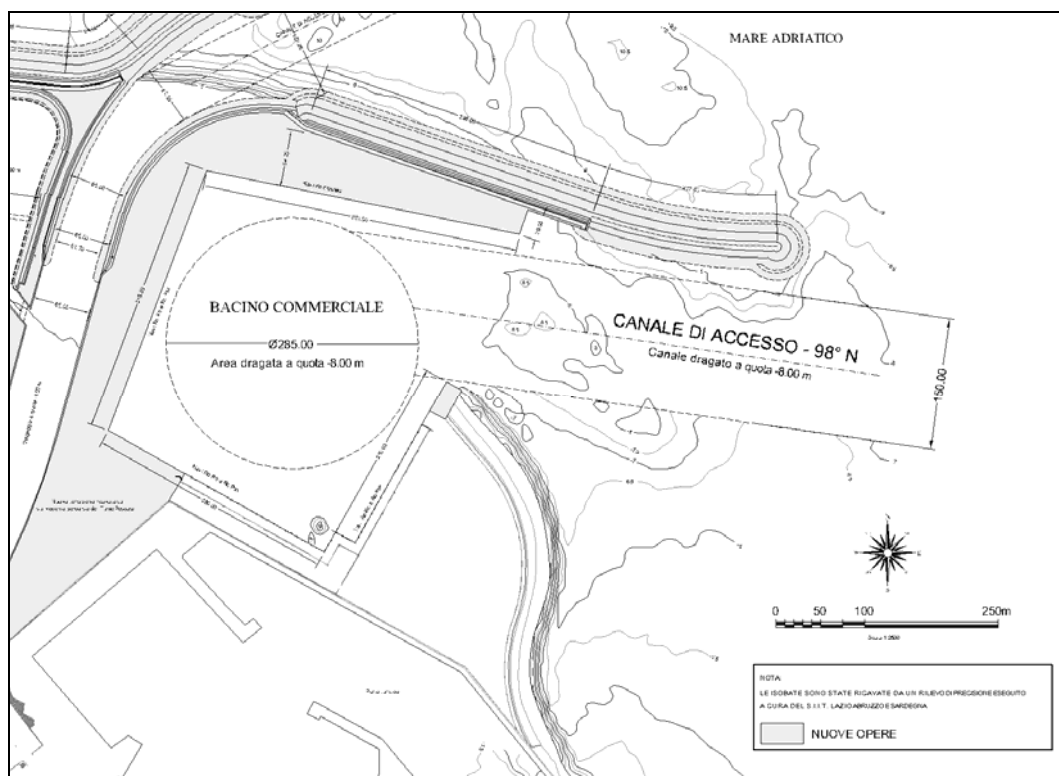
Bacino commerciale: planimetria di progetto con l'indicazione del canale di accesso
